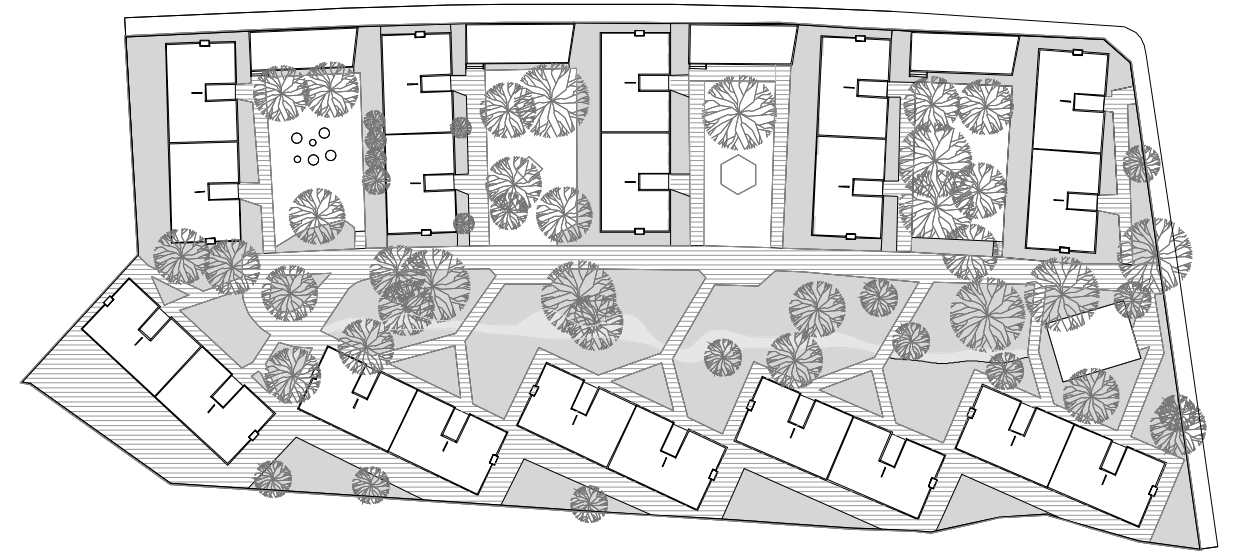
,89, 90 y 91. Dibujo de Planta tipo, Planta de Techos , Sección Longitudinal y Sección Transversal del Grupo Residencial Salduba 2020. E. 1:1000
